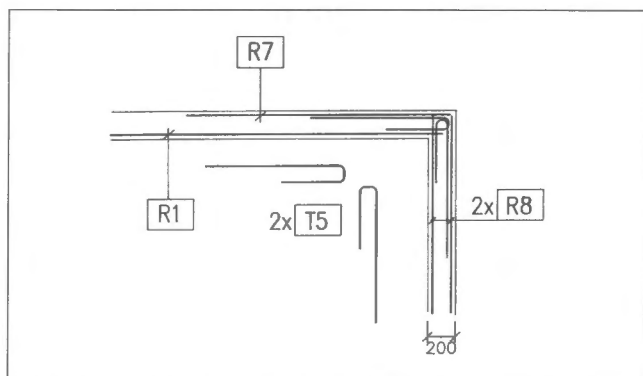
Skládání dvou třmínkových prvků do víceštržných třmínkových košů různé šířky / Arrangement of two stirrup elements into multi-shear stirrup cages of different width
